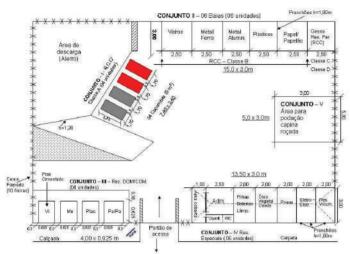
Proposta de planta de ECOPONTO Fonte: SERENCO. 2.012.
